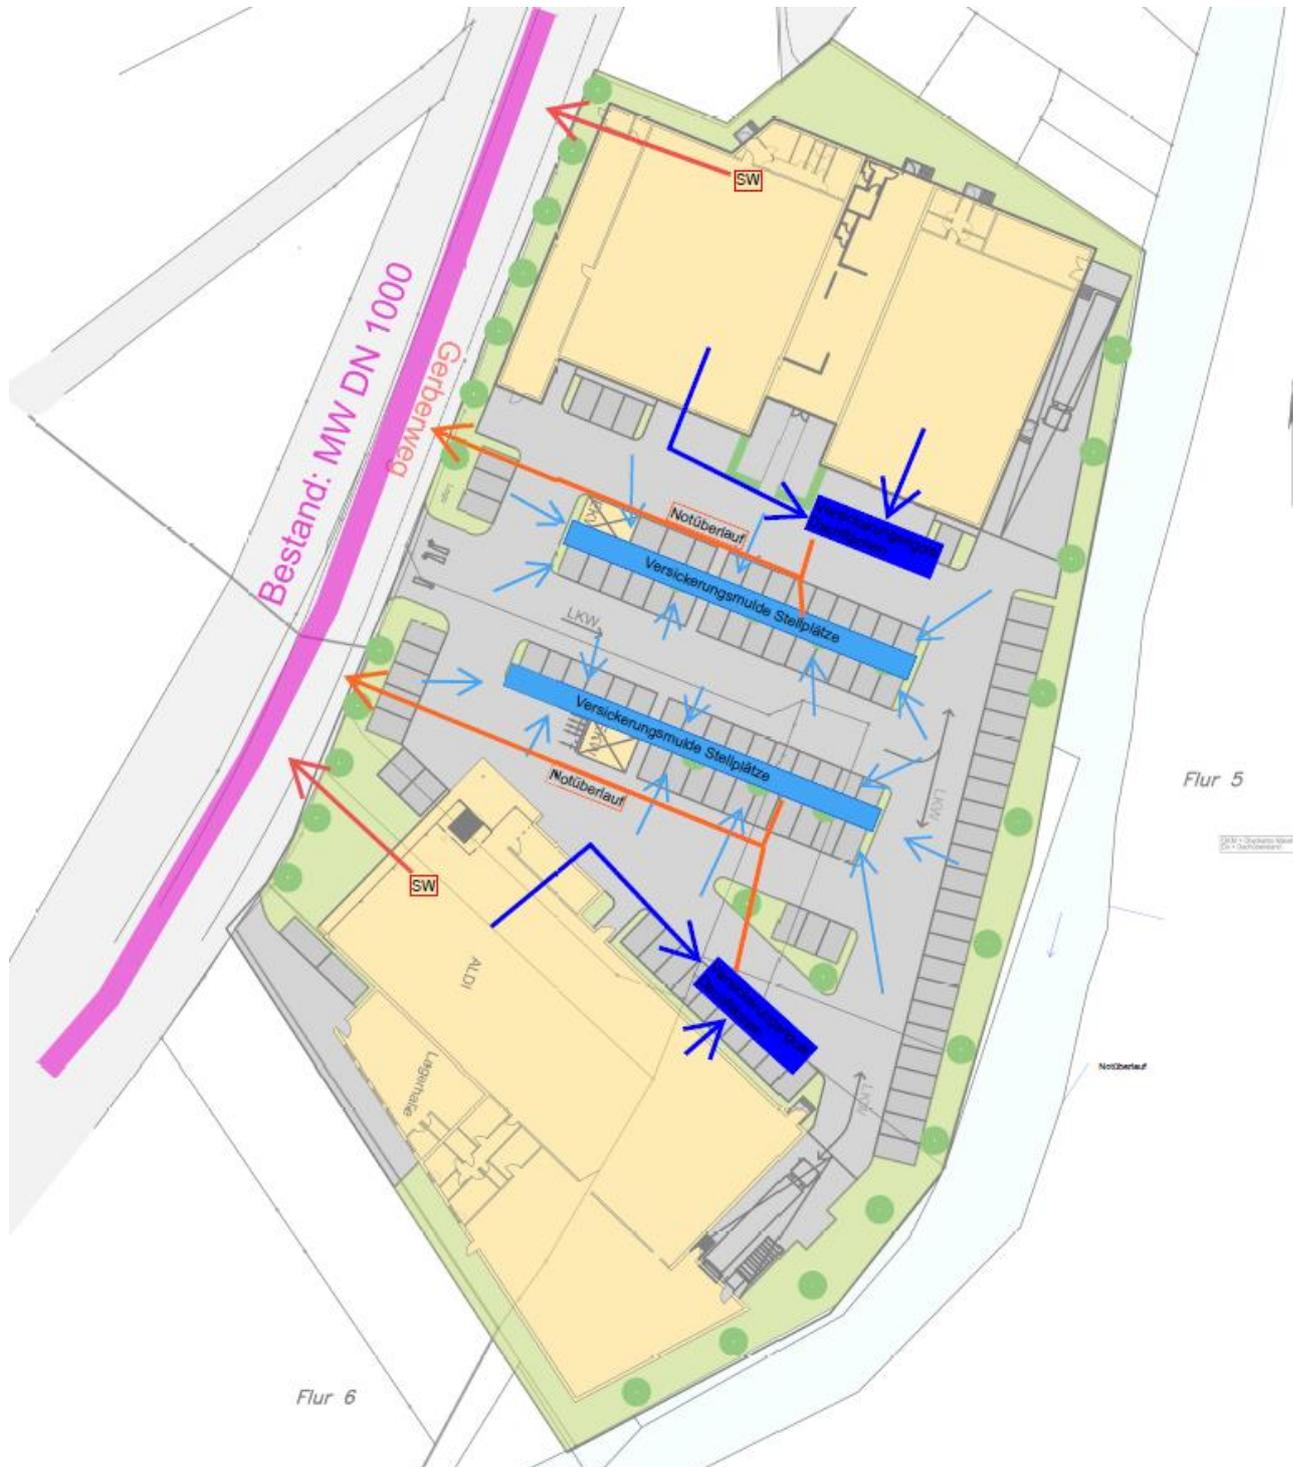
Geplante Niederschlagsentwässerung im Plangebiet
